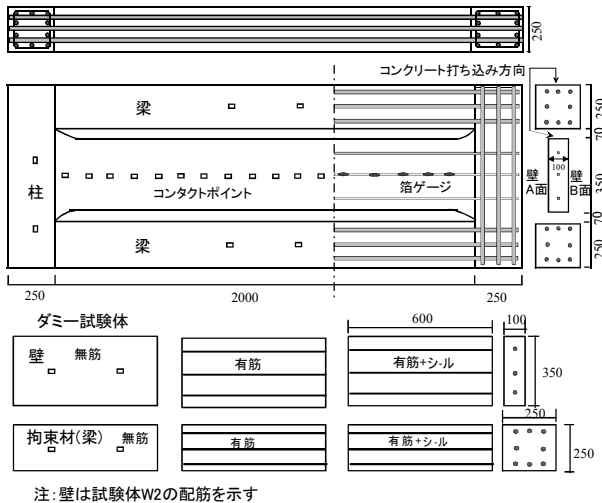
収縮拘束ひび割れ試験体とダミー試験体
